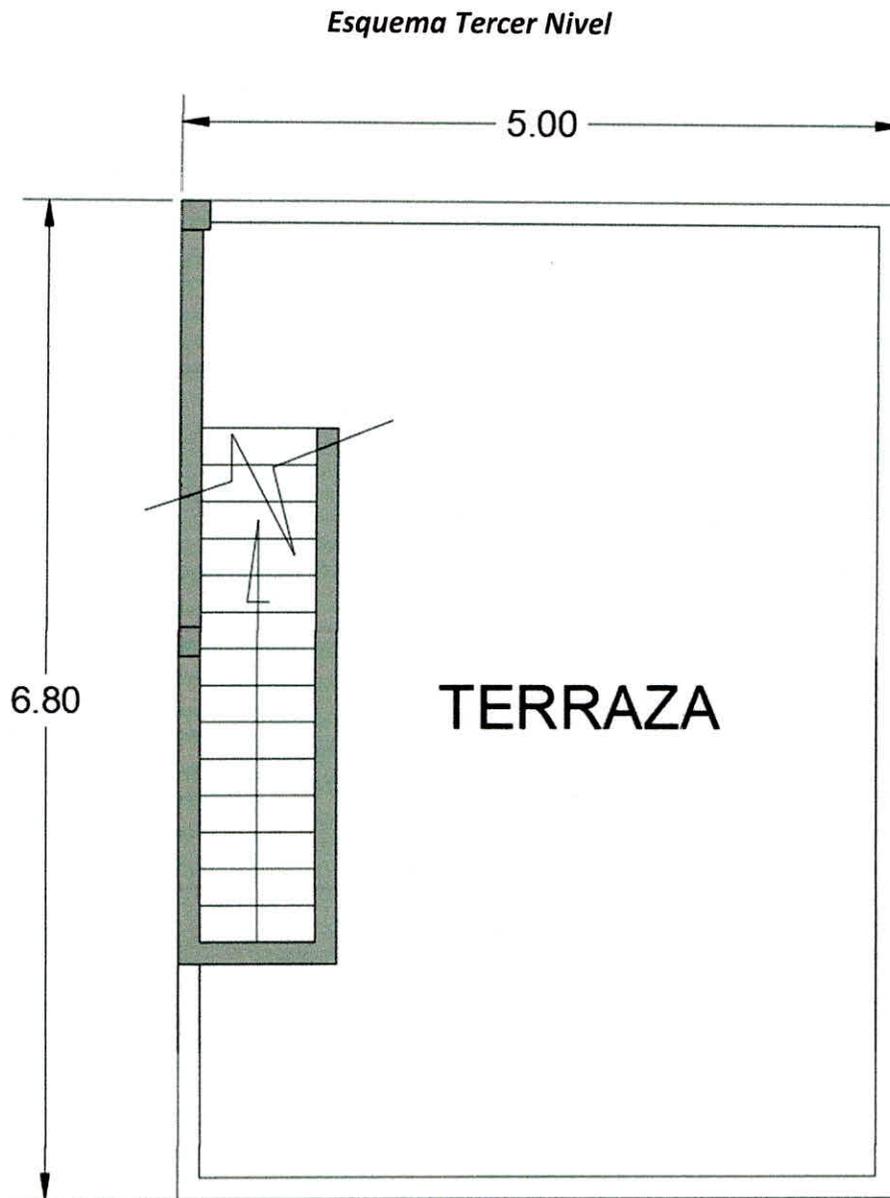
Esquema de distribución de dependencias al interior del inmueble Fuente: Elaboración propia (áreas esquemáticas y aproximadas tomadas en sitio).
